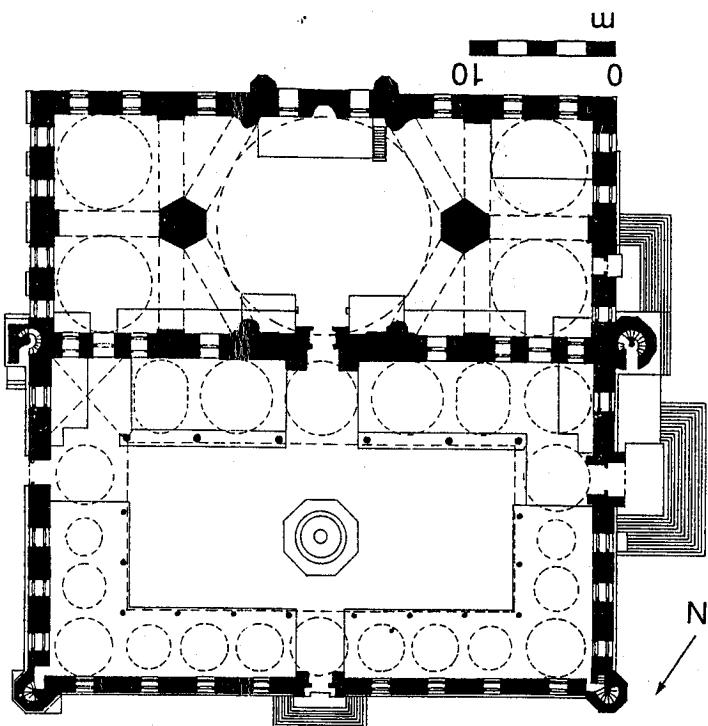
المسقط الأفقي لمسجد بلخ بأفغانستان (٩٥٣ / م٩)
